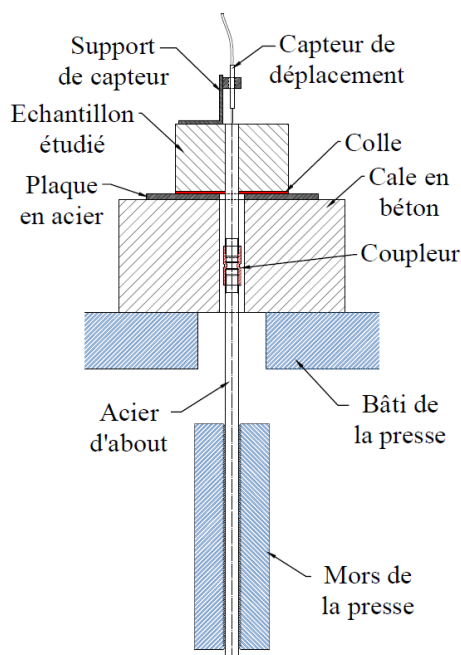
Disposition de coupleurs et d'aciers d'about pour les essais de pull-out sur éprouvettes armées longitudinalement L1,1%-TØ préalablement débitées.
